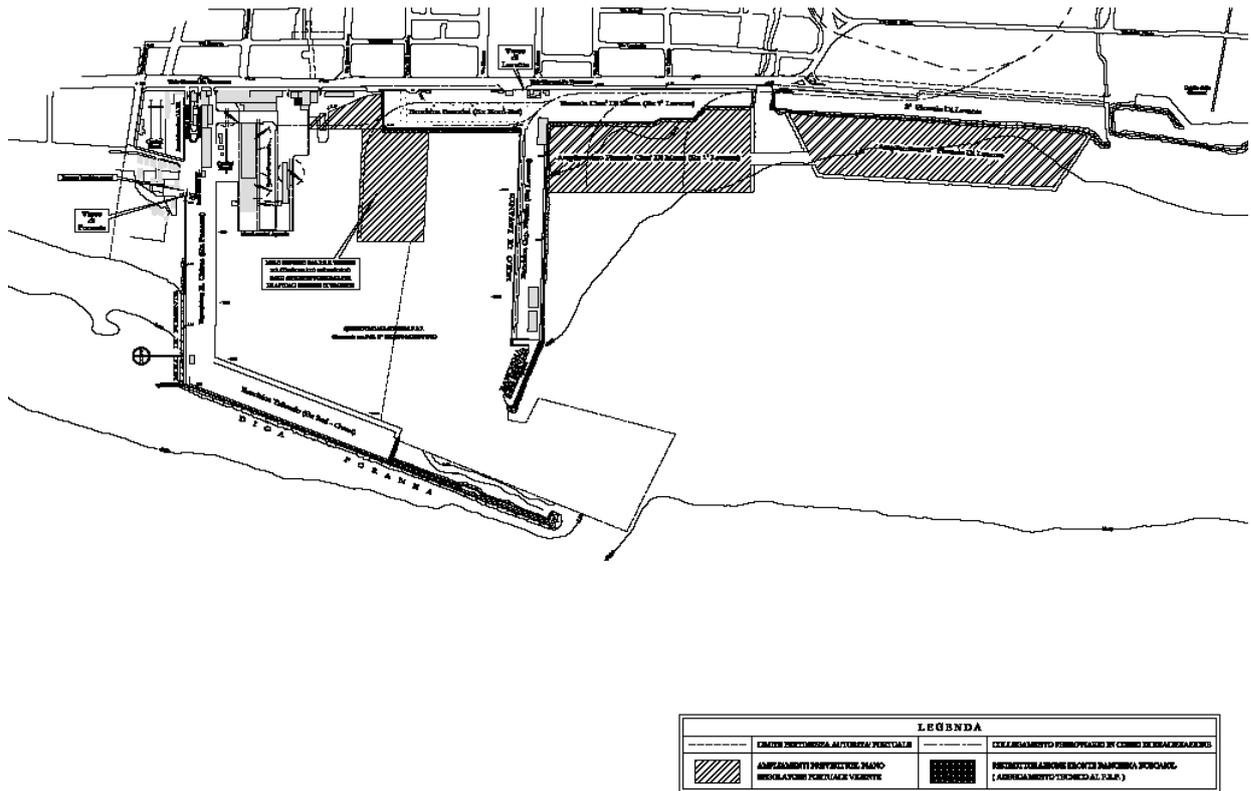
Planimetria della configurazione prevista dal piano regolatore portuale vigente del 1981 (FONTE: Autorità Portuale di Marina di Carrara)
